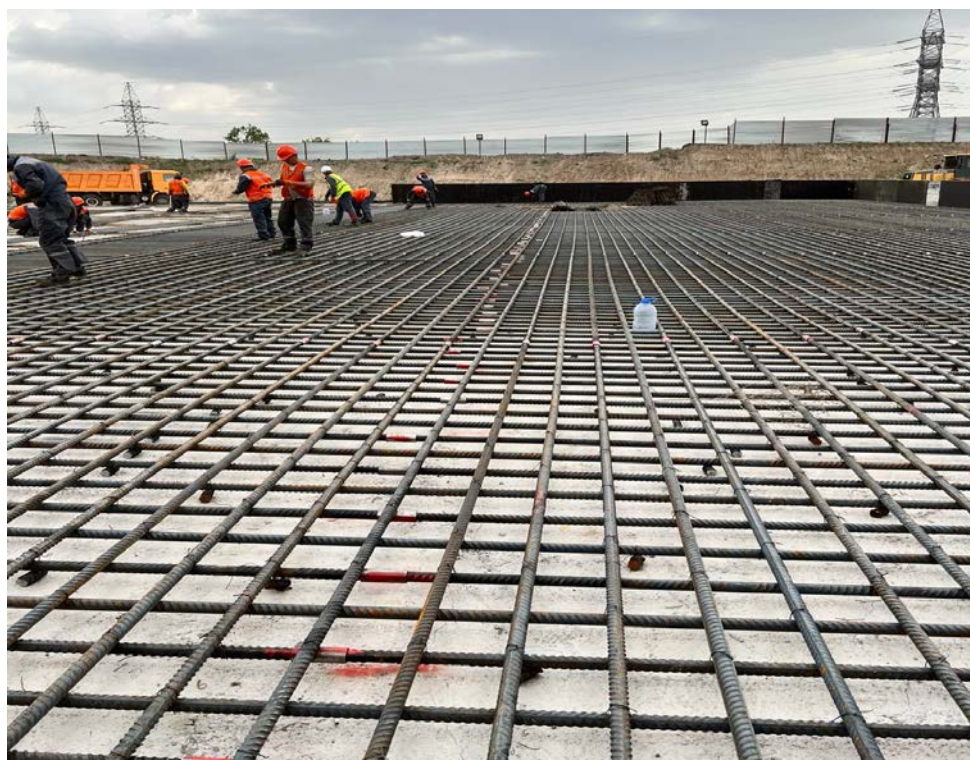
Соединение арматуры методом механического соединения (муфт) при армировании монолитной плиты тоннеля на развязке ул.Саина и ул.Акын Сара в г.Алматы
